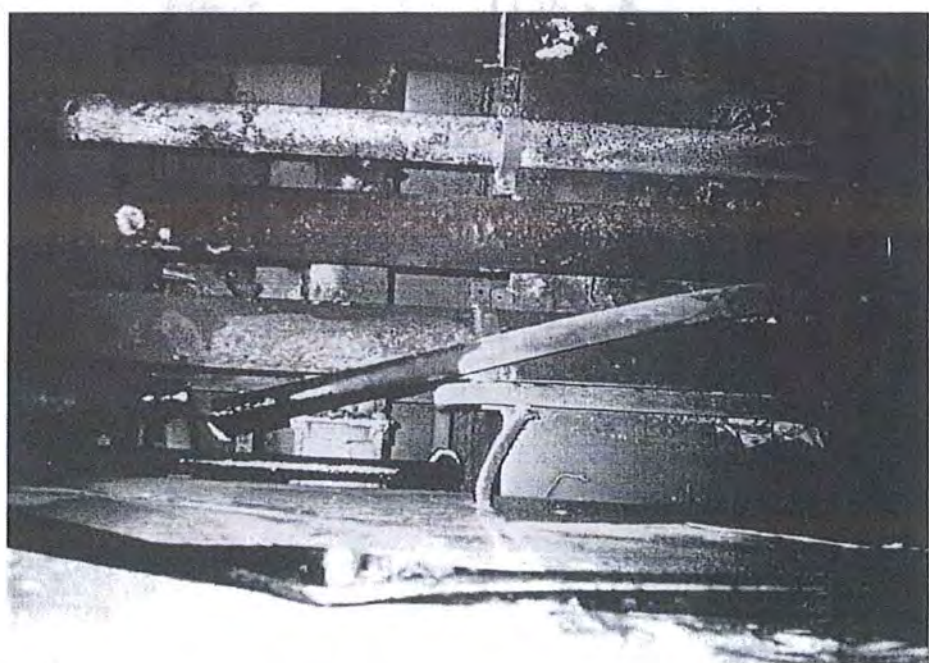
Samme sted som foto nr. 1. Retuolierøret er bukket.
